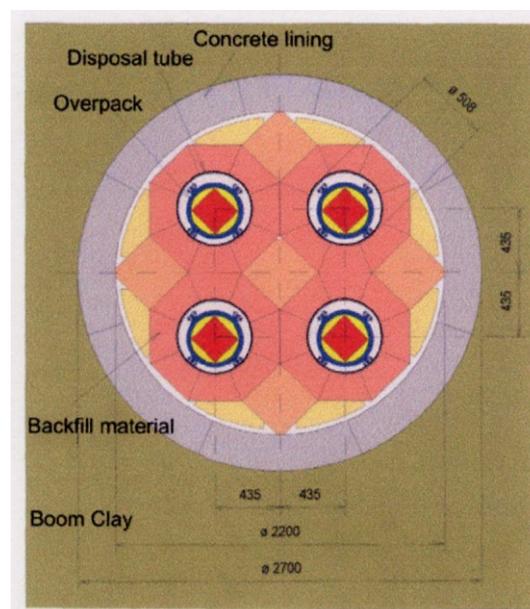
Querschnitt durch eine Einlagerungsstrecke für ausgediente Brennelemente /3-4/
